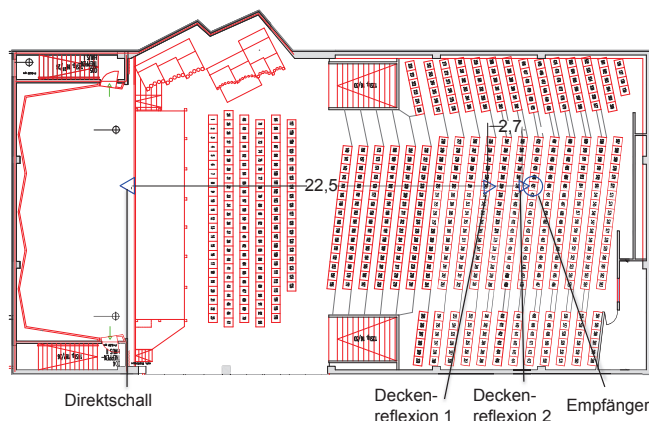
Grundriss Konzerthaus Detmold mit Sender- und Empfängerposition.
